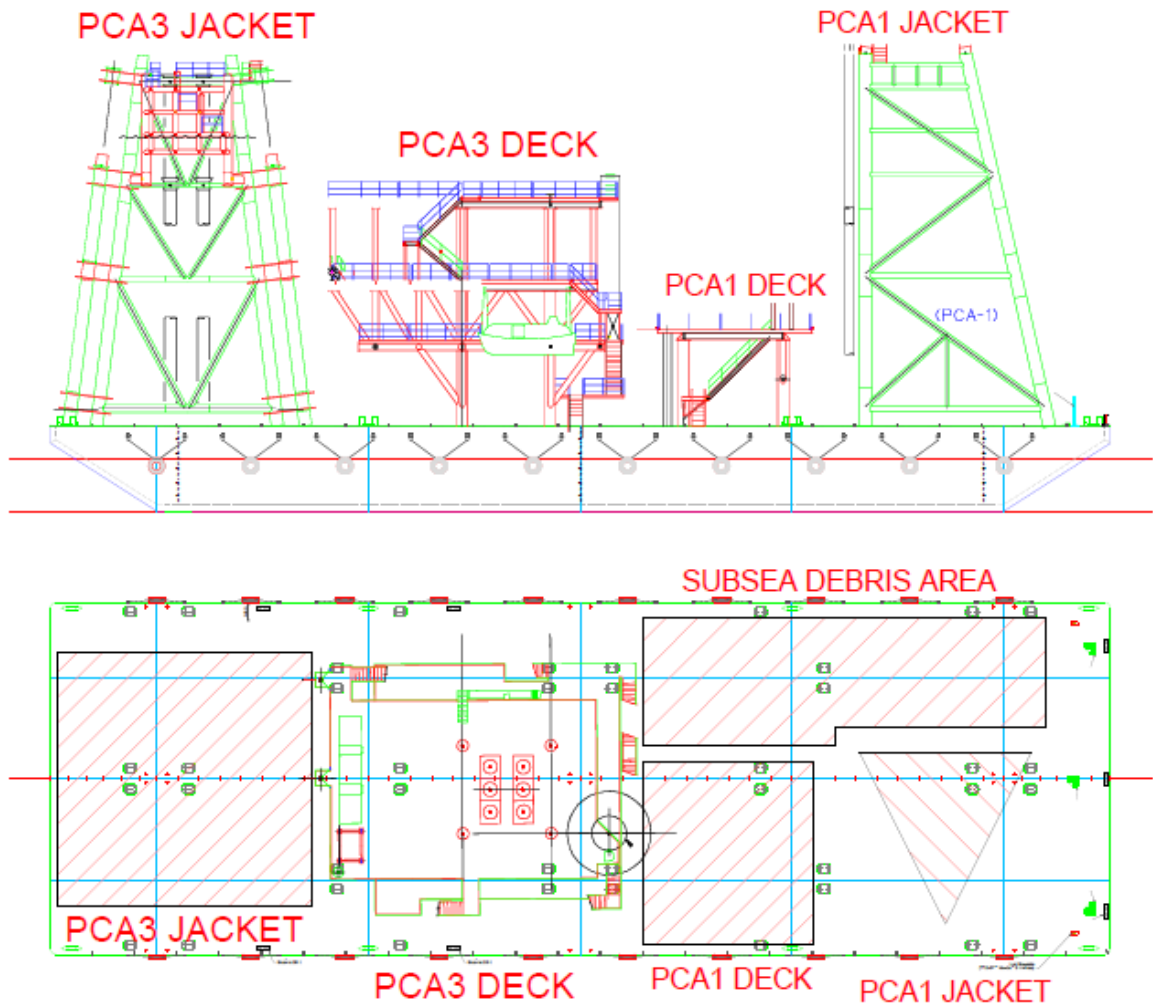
(2) – Arranjo de estruturas e matérias a bordo da Balsa de Serviço nº 2.
